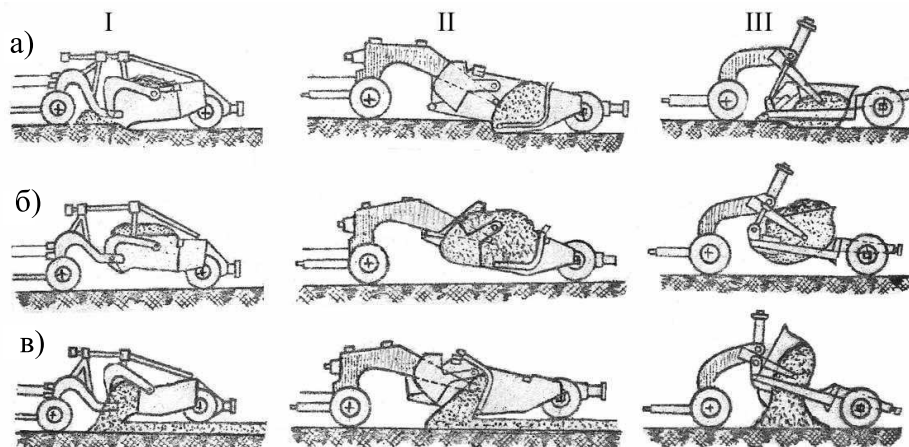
Схемы устройства и работы скреперов: I – с принудительной разгрузкой; II – полупринудительной разгрузкой; III – со свободной разгрузкой; а) – загрузка; б) – транспортное положение; в) – разгрузка
